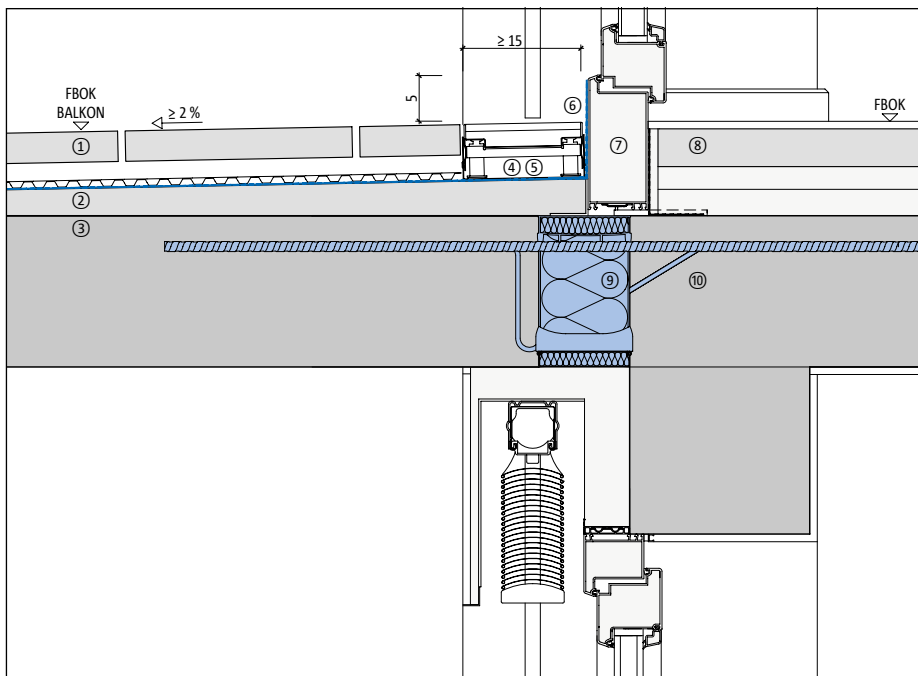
| M. 1:10 Fertigteilbalkon ohne Aufbau
